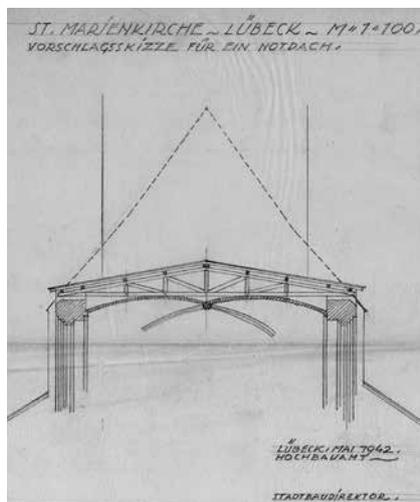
Notdachentwurf von Hans Pieper, Mai 1942 (Foto: Nachlass Overhage)
